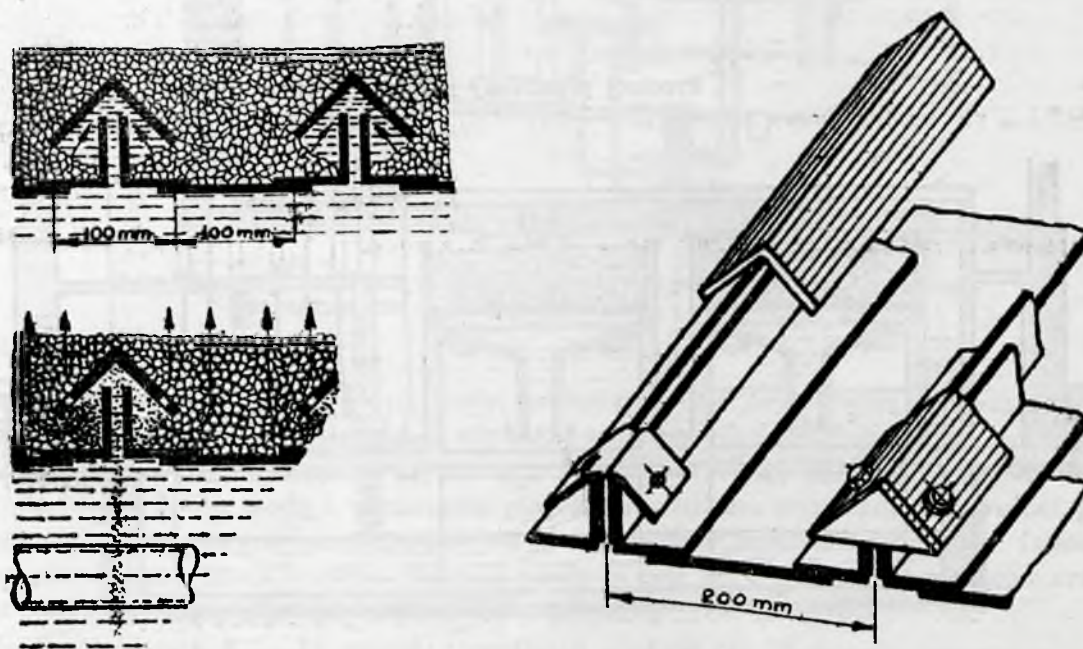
Układ przewodów doprowadzających powietrze, przewody wody zabetonowane w dnie.
